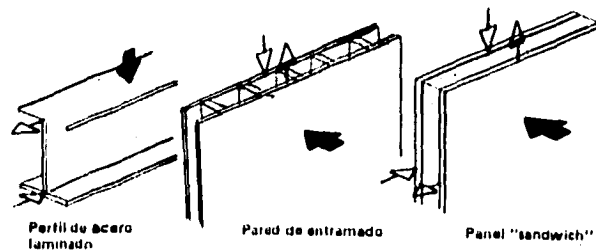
Vigas, paredes de entramado y panel laminar o "sandwich".
